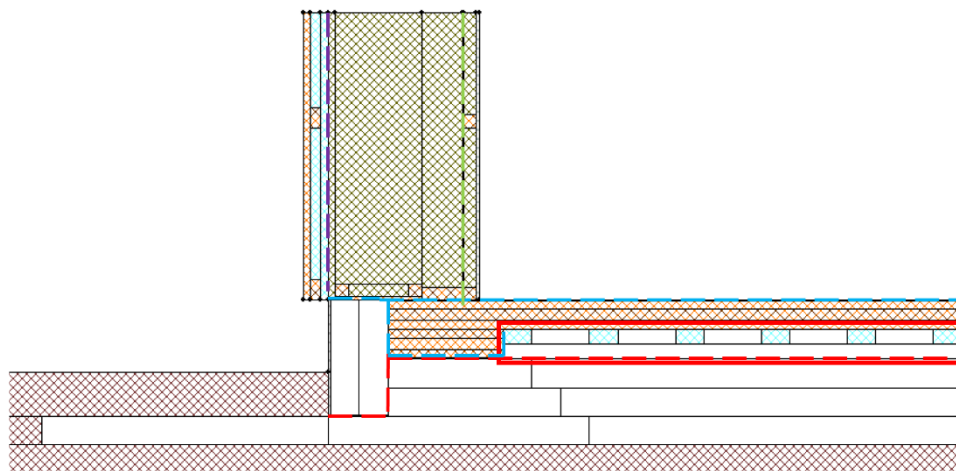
Folos-diagram för Trägrund 2.0 och Trägrund 2.7.
